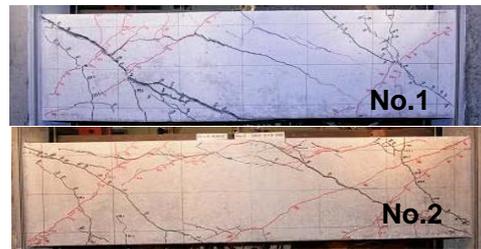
ほぼ最大耐力時のひび割れ状況
